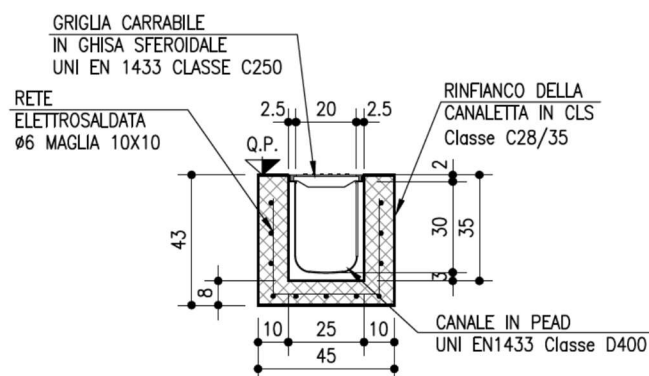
Canaletta per il drenaggio dei parcheggi
